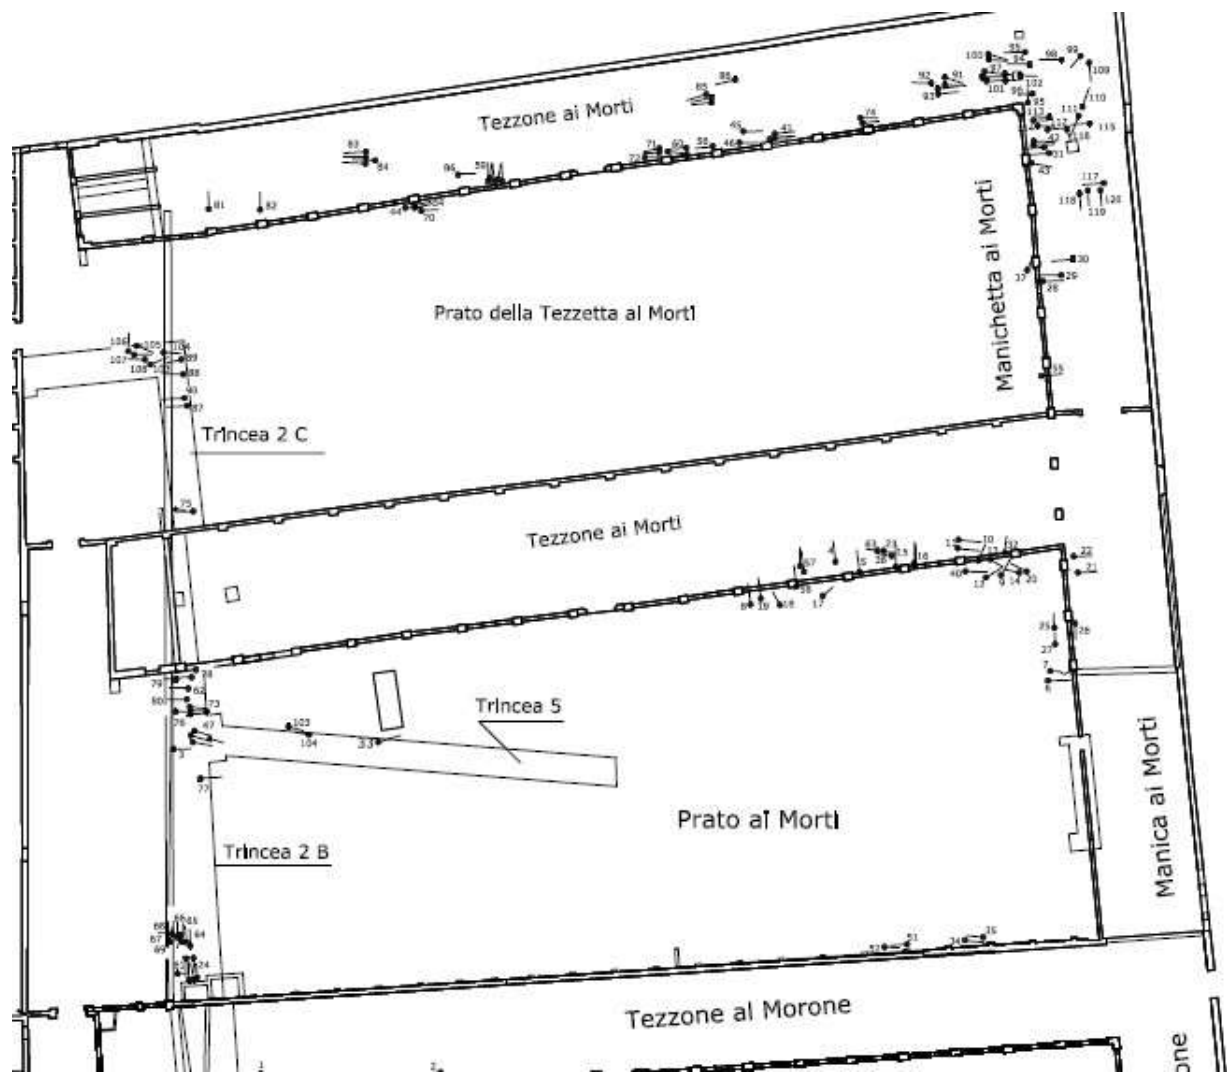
Dettaglio della pianta di scavo con localizzazione delle Tombe (SABAP Rel. N. 1957).
